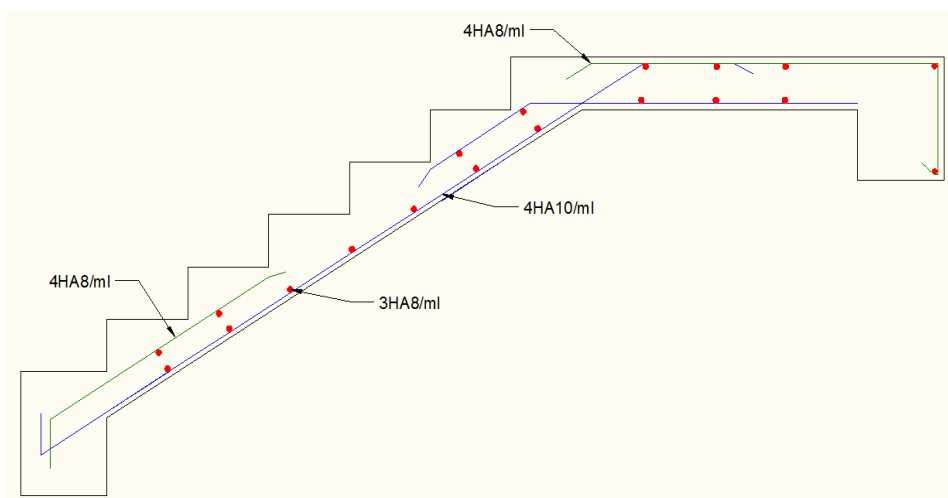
Schéma de ferrailage de l'escalier type 1.
